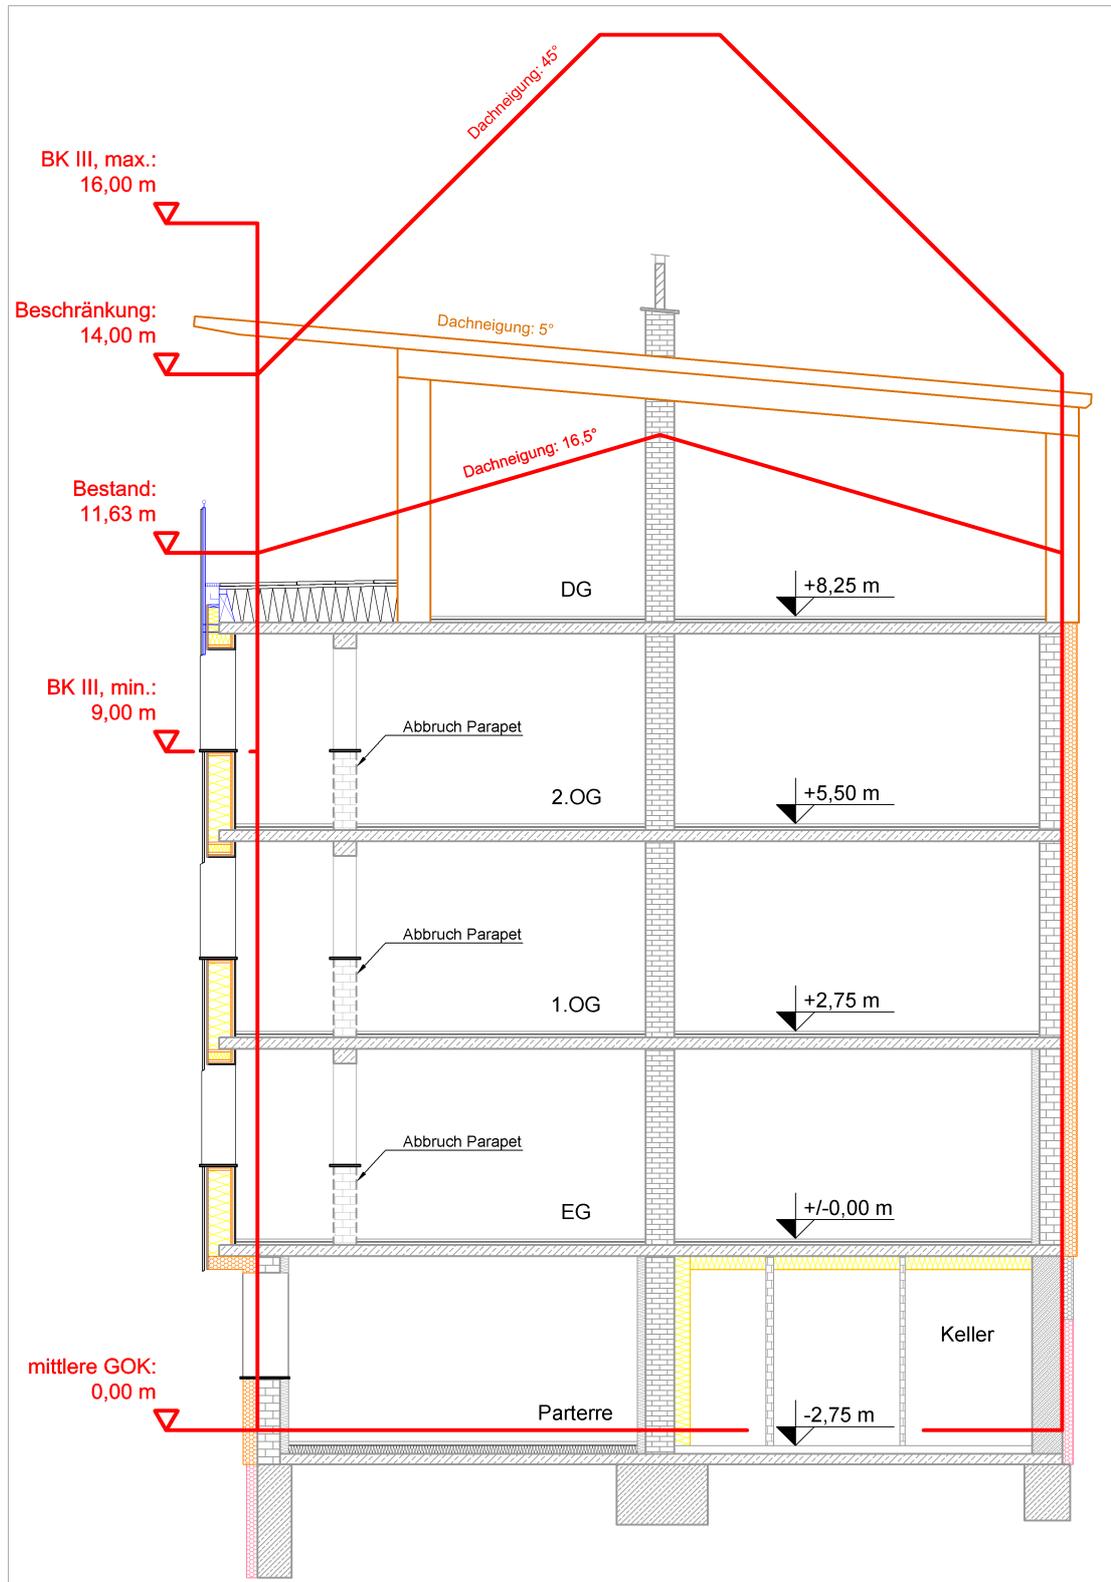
Gebäudeschnitt der Sanierungsvariante *Passivhaus mit Dachgeschoß*, M 1:100
